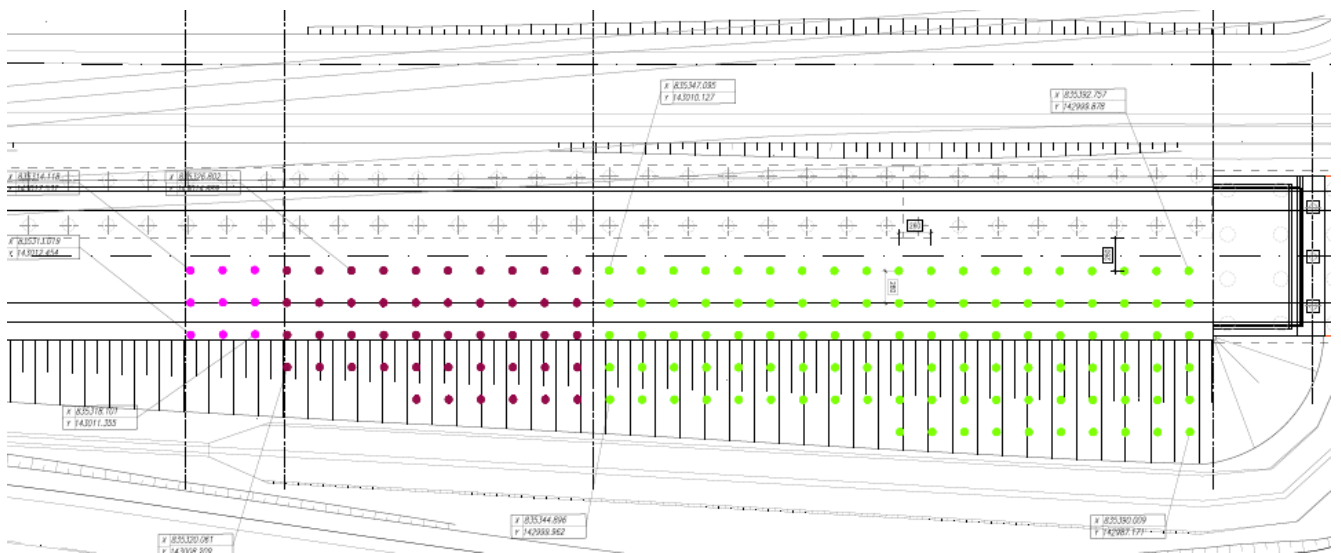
Rilevato di approccio spalla A – Planimetria di progetto delle inclusioni rigide
